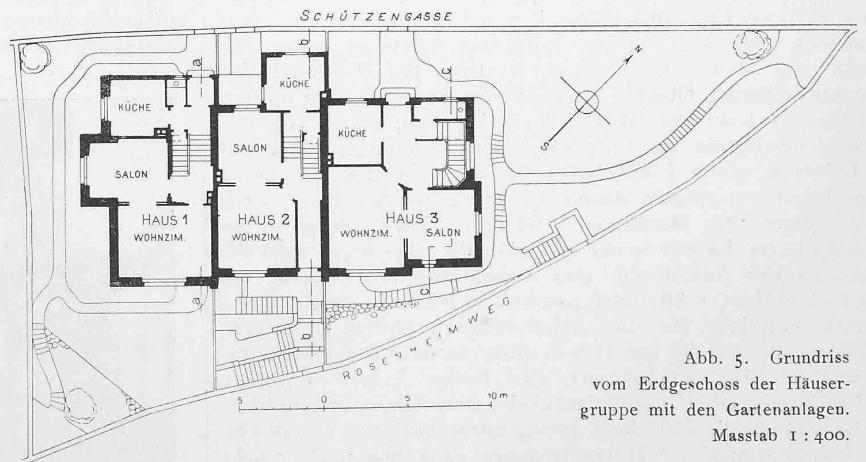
Grundriss vom Erdgeschoss der Häusergruppe mit den Gartenanlagen. Masstab 1 : 400.
